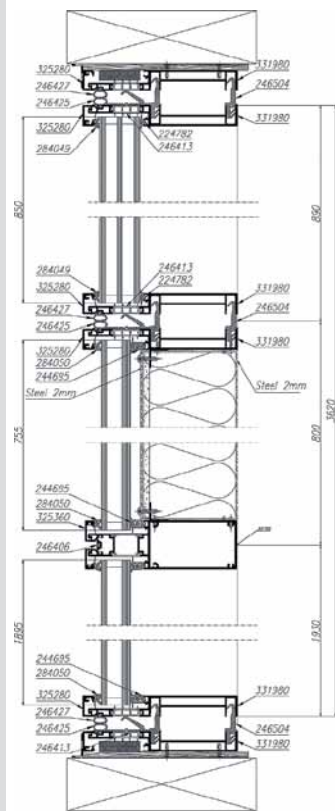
Вертикальный разрез фасадной конструкции Schüco USC 65
